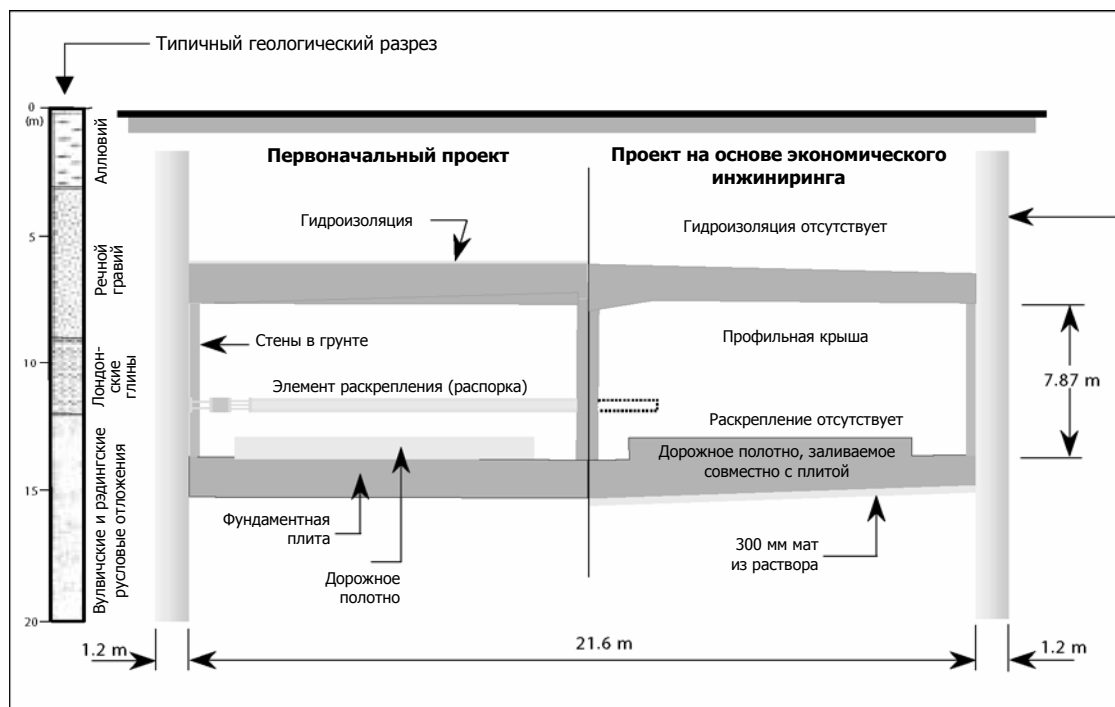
Поперечное сечение площадки строительства Лаймхаус Линк (прокладка тоннеля открытым способом)
